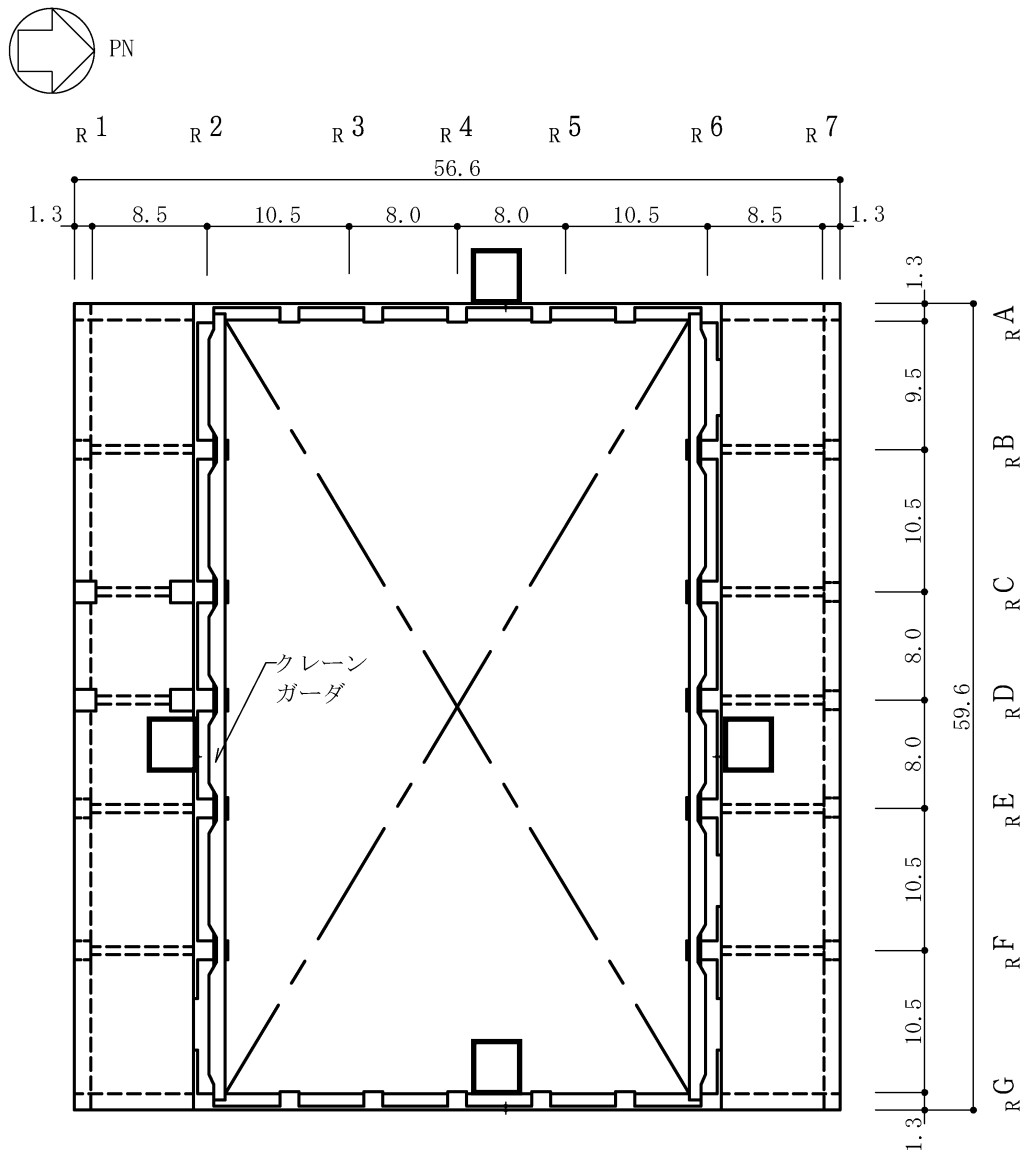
原子炉建屋の概略平面図 (CRF, T.M.S.L. 38.2m) (単位 : m) (8/9)
